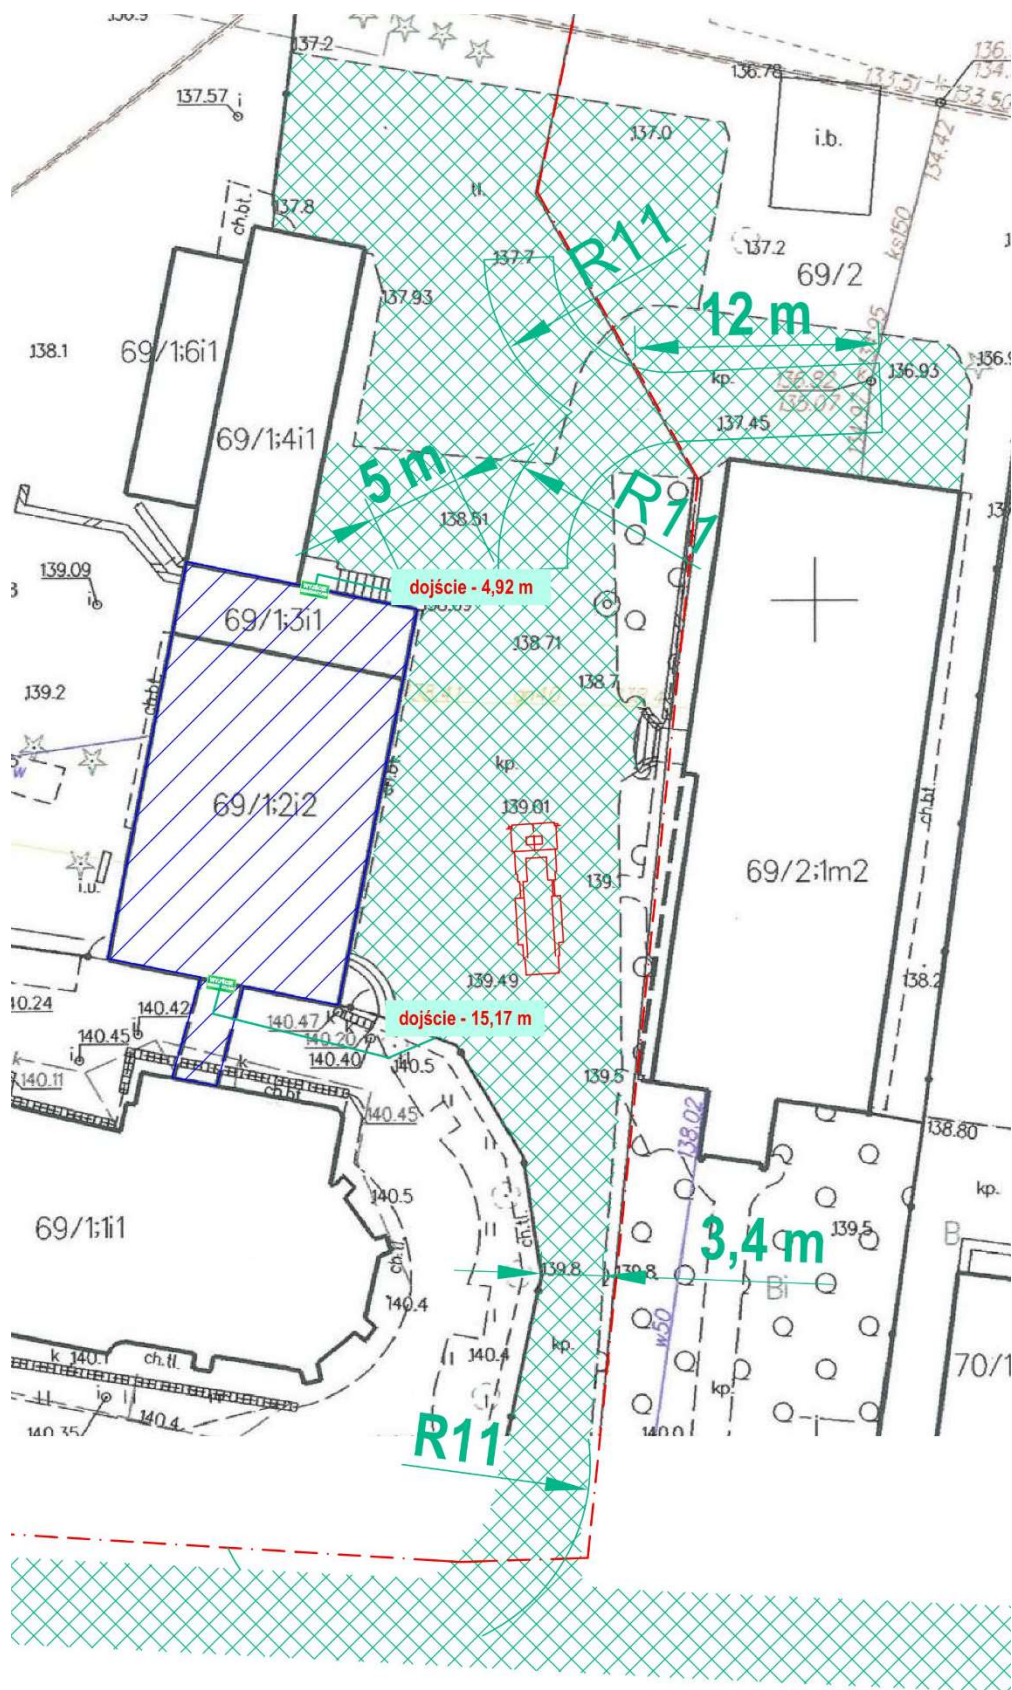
Widok placu manewrowego przed obiektem – plac wewnętrzny.
